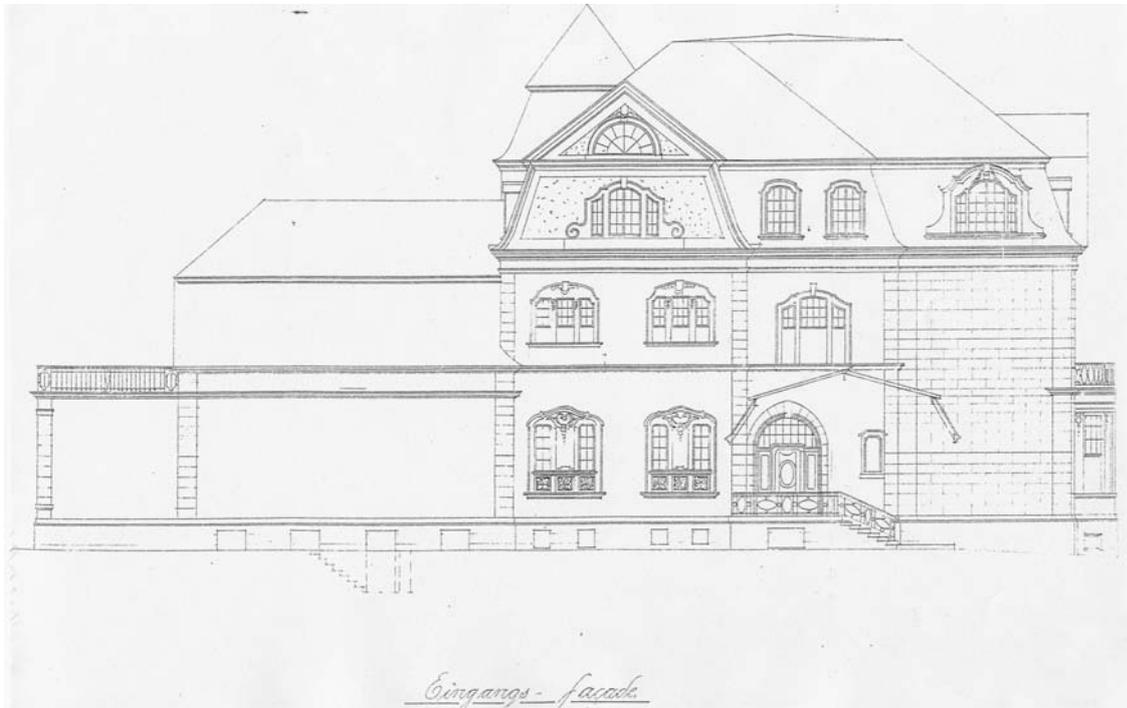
H. Plange, Wohnhaus Röder, Eingangsfassade, Aufriss 1904
